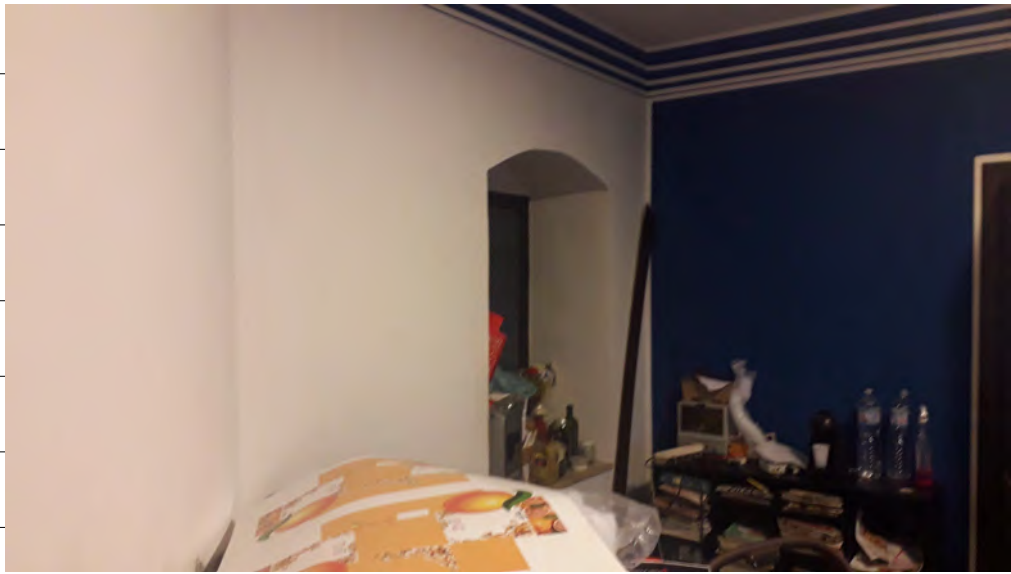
immagine interna del locale adibito a camera (1) ubicato al primo piano dell'edificio ed attualmente usato come ufficio.
